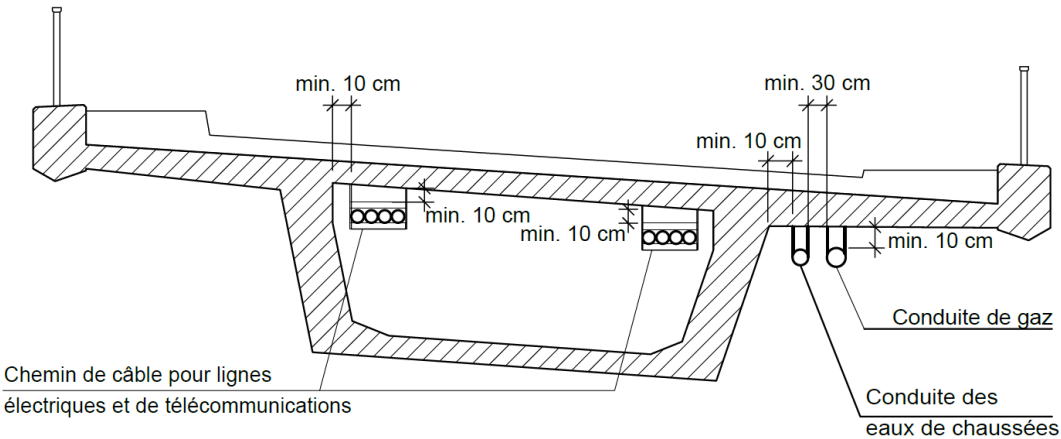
Coupe transversale d'un pont à caisson avec diverses conduites techniques
